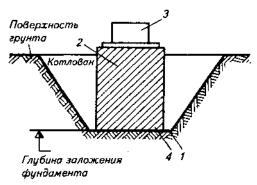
Схема устройства фундаментов: 1 — основание; 2 — фундамент; 3 — машина; 4 — подошва фундамента
